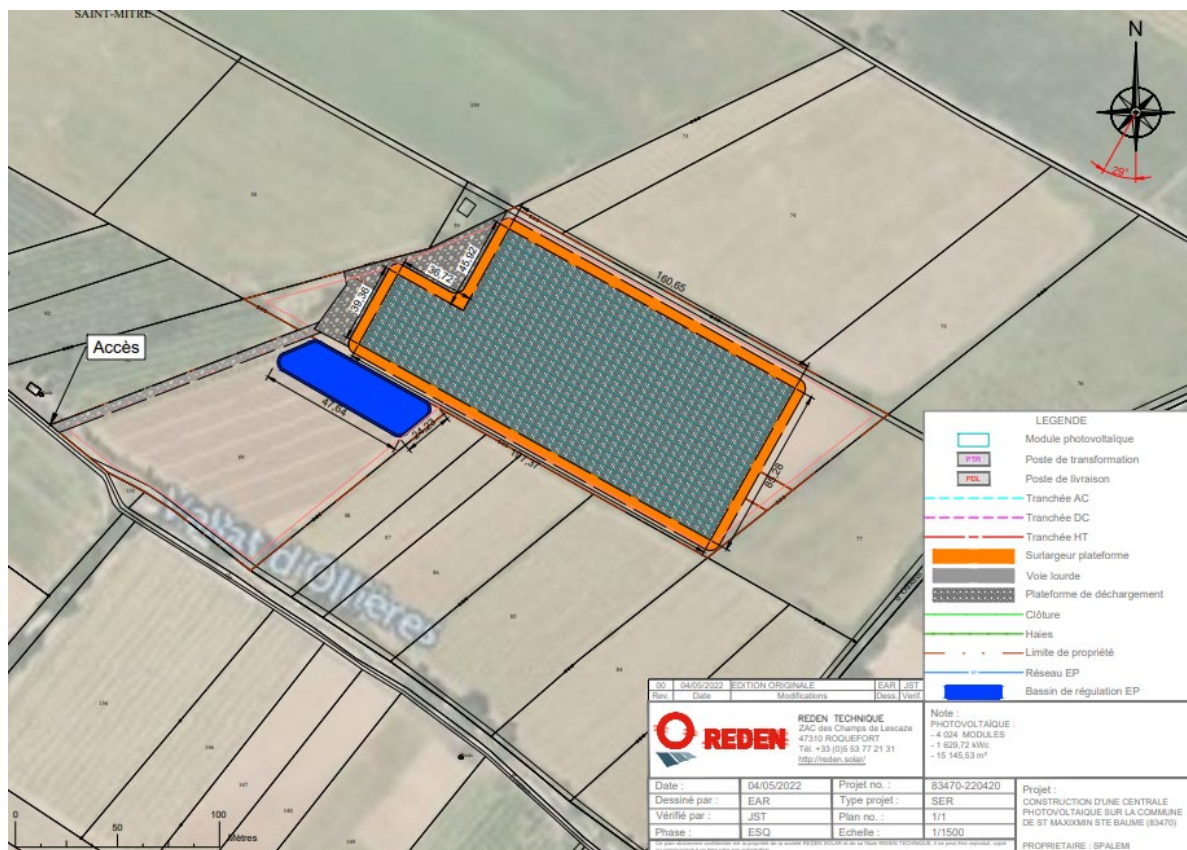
Implantation du projet : plan de la serre. Source : REDEN, 2022.
